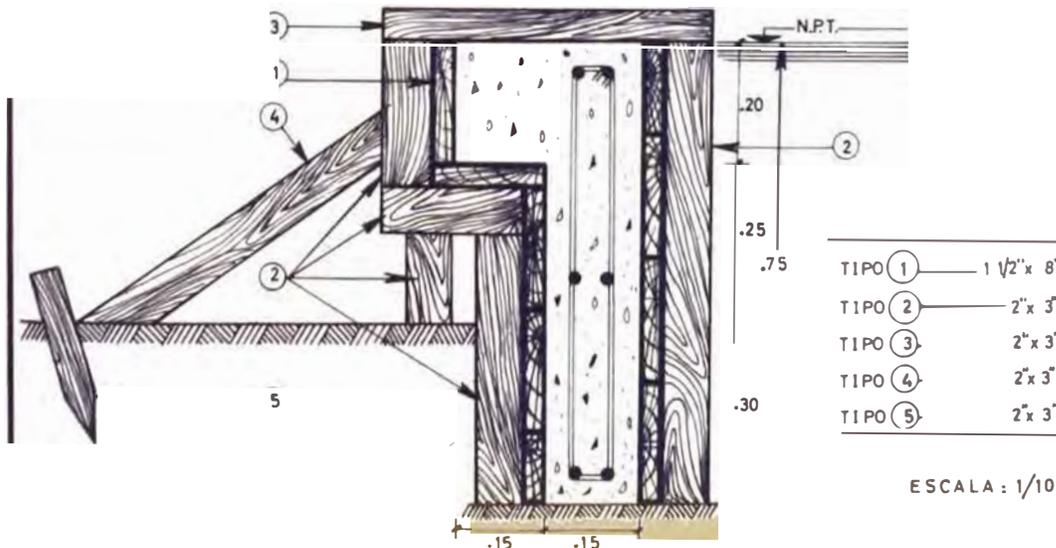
ENCOFRADO DE VIGA DE CIMENTACION CORTE X-X
